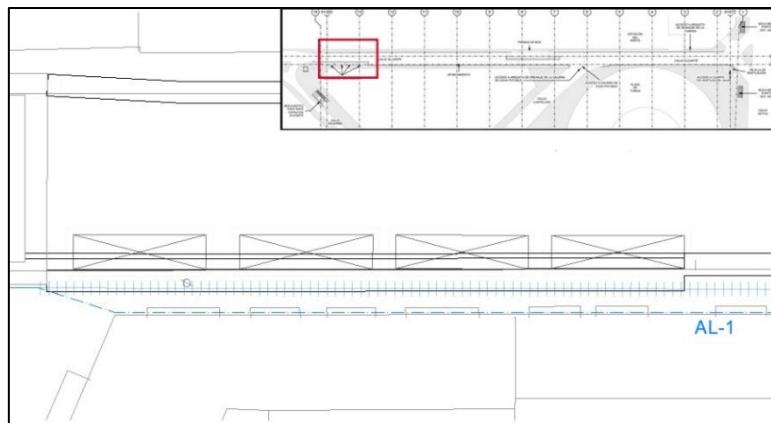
Plano de desvío ALUMB-AL1-RP-SC-F3
